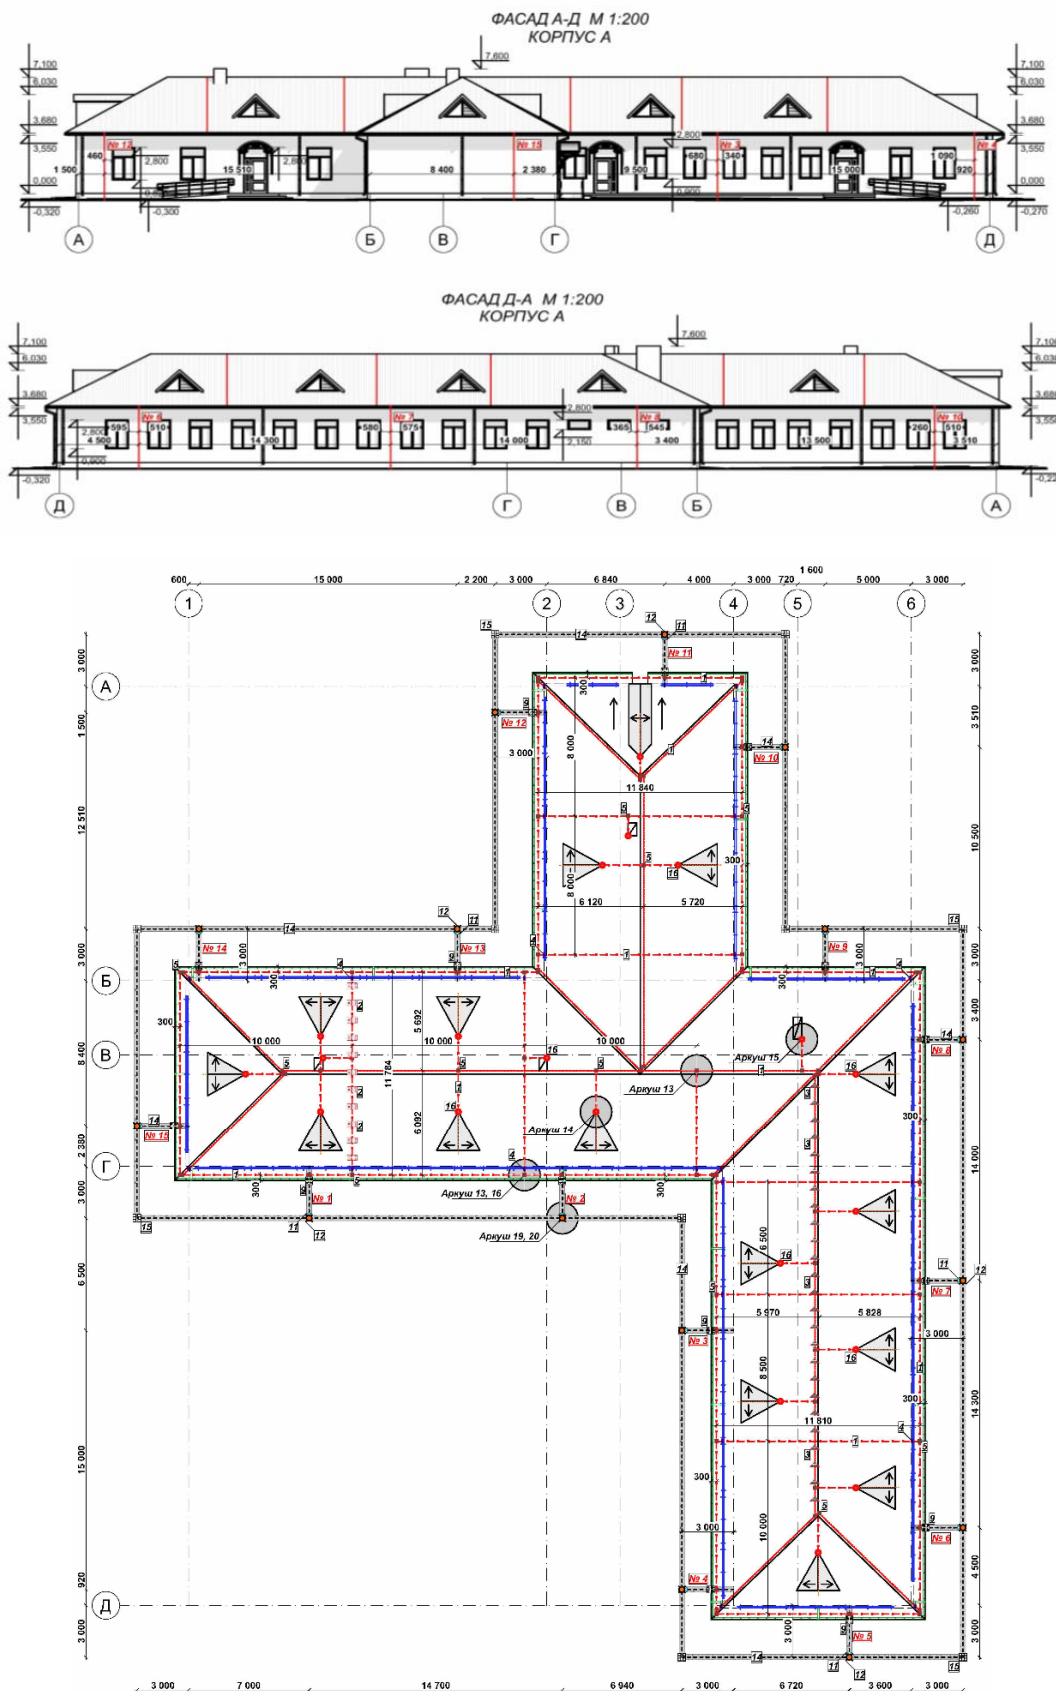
Об'ємно-планувальне рішення будівлі ліцею
